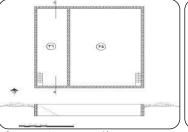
مسقط أفقى للدور الأول لقلعة البئر الجديد (رسم بمعرفة الباحث)
